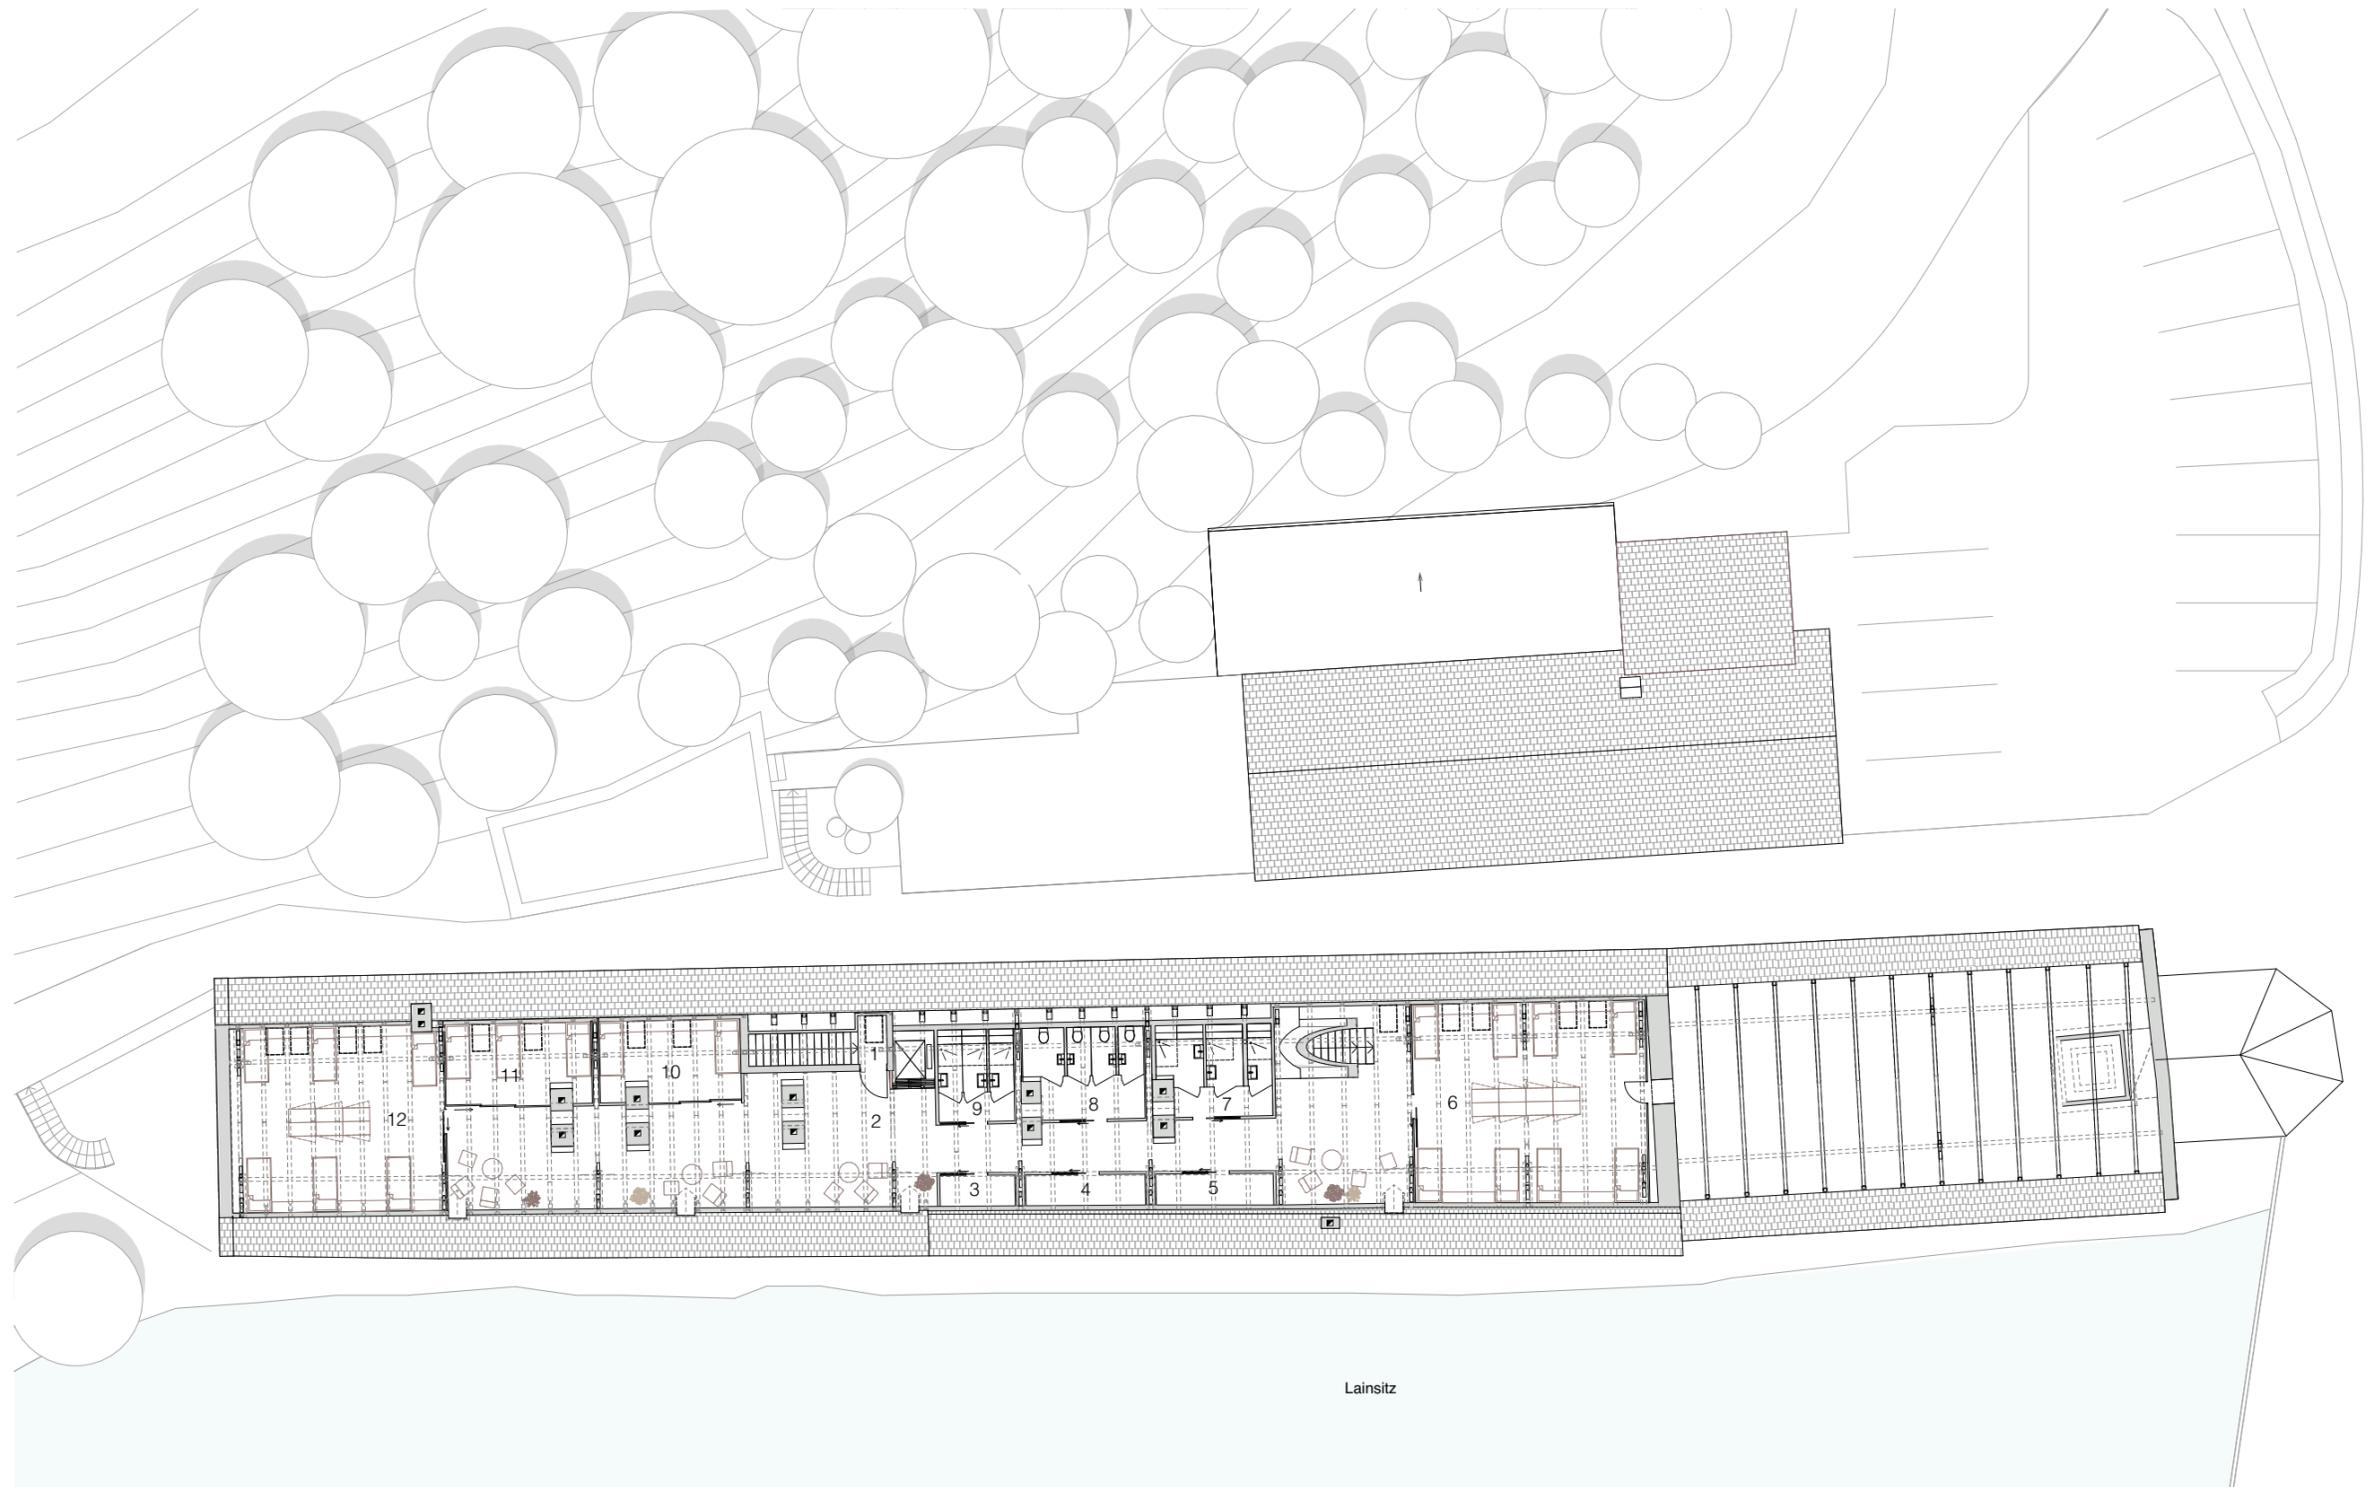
Entwurf. Dachgeschoss Spitalstrakt und Spitalkirche, Dachdraufsicht Wirtschaftstrakt
